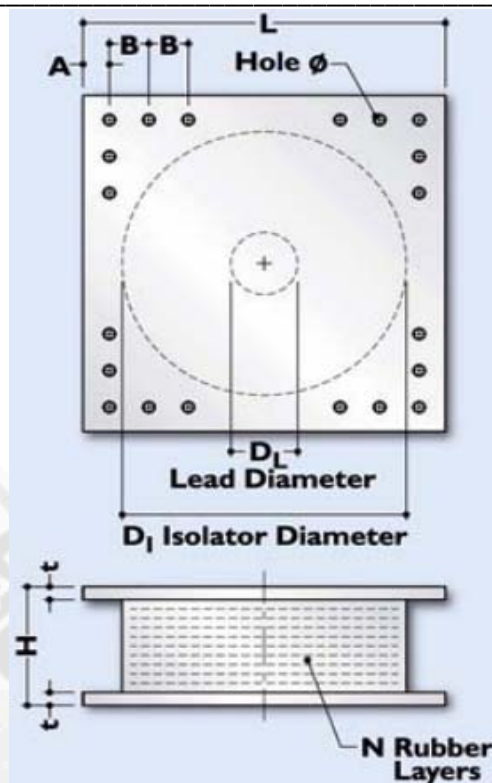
a. Detalles de montaje proporcionado por el fabricante
